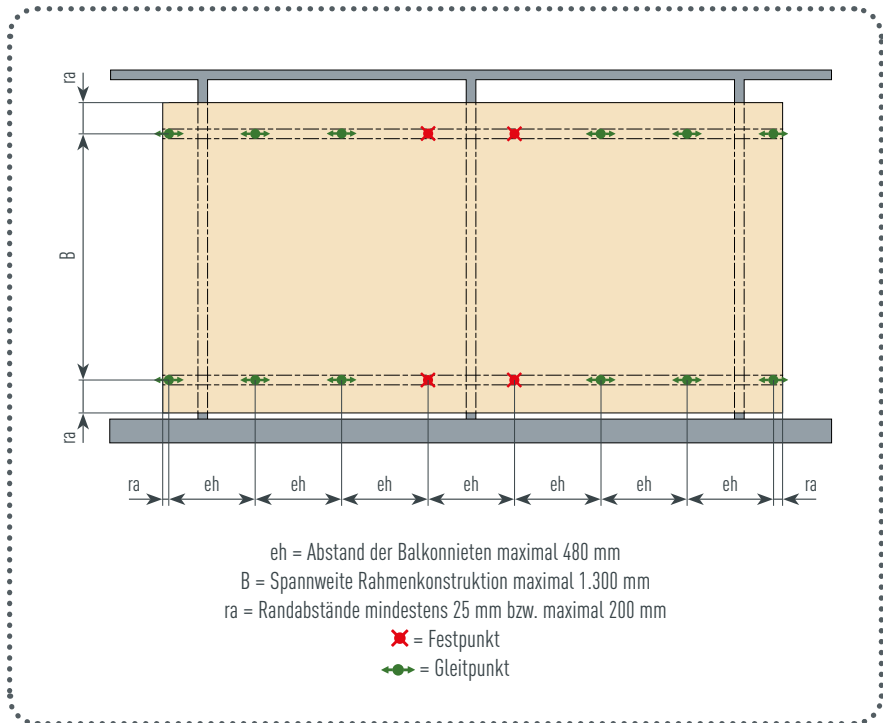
· PREFABOND Aluminium Verbundplatte auf horizontaler Rahmenkonstruktion
